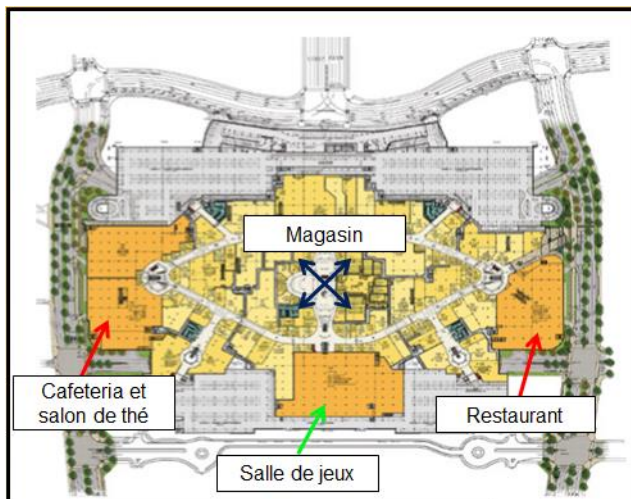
Plan 3<sup>ème</sup> étage commerces de niveau inférieur et parking
